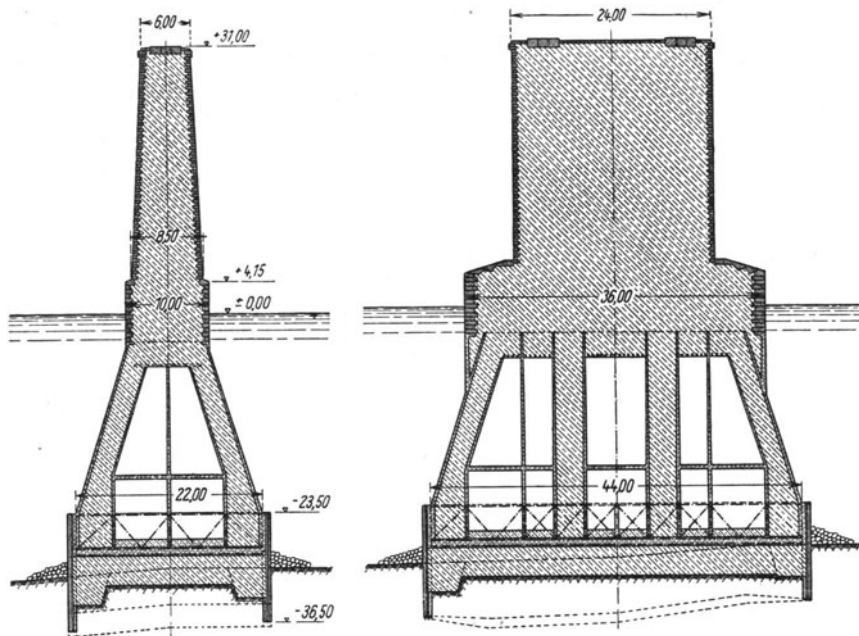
Pfeiler für die Brücke über den Kleinen Belt. Ausgeführter Entwurf von Grün & Bilfinger, Krupp A.-G., L. Eilers, Monberg & Thorsen. (Nach G. Schaper: Bautechnik 1929 S. 190.)
